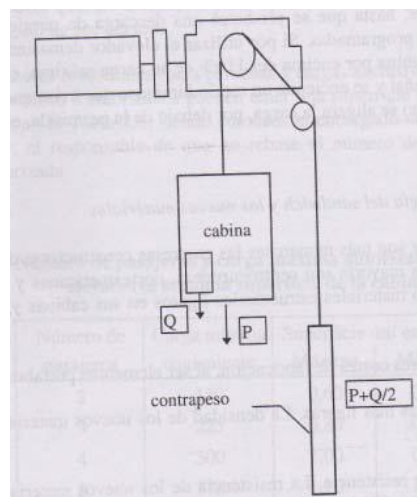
Esquema de fuerzas en cabina y contrapeso
